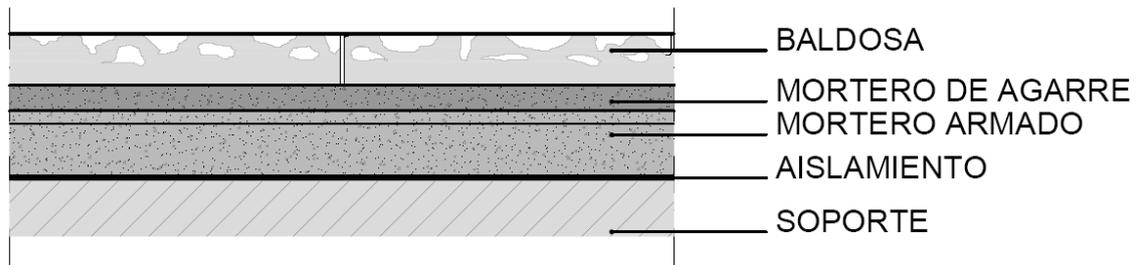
Ejemplo de colocación sobre base de mortero armado
